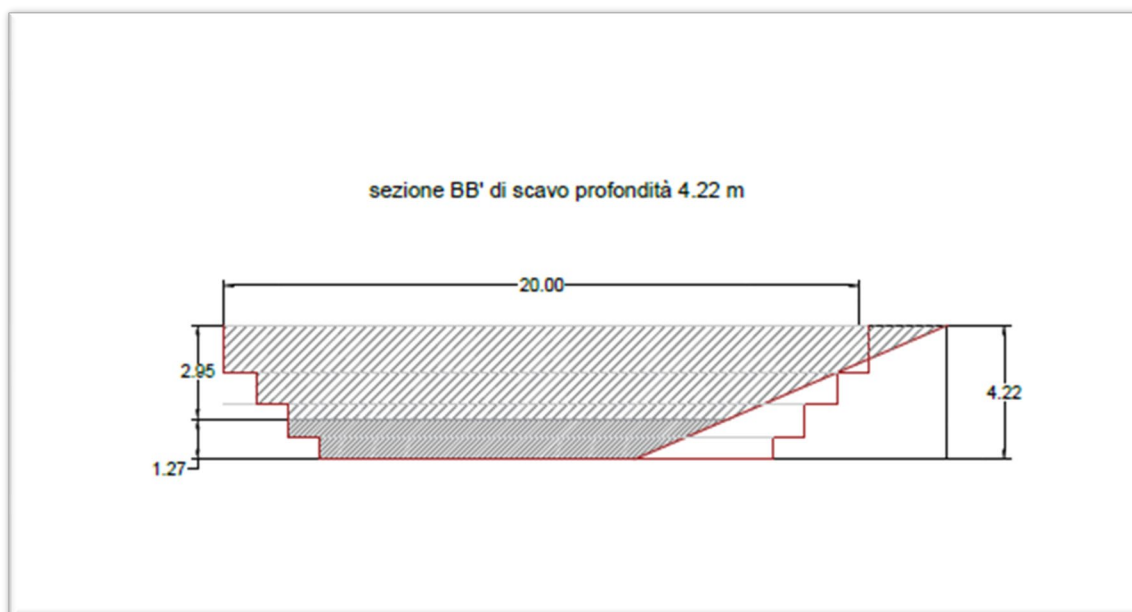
Sezione longitudinale tipo di trincea di scavo della Trincea 20 x 10 m
